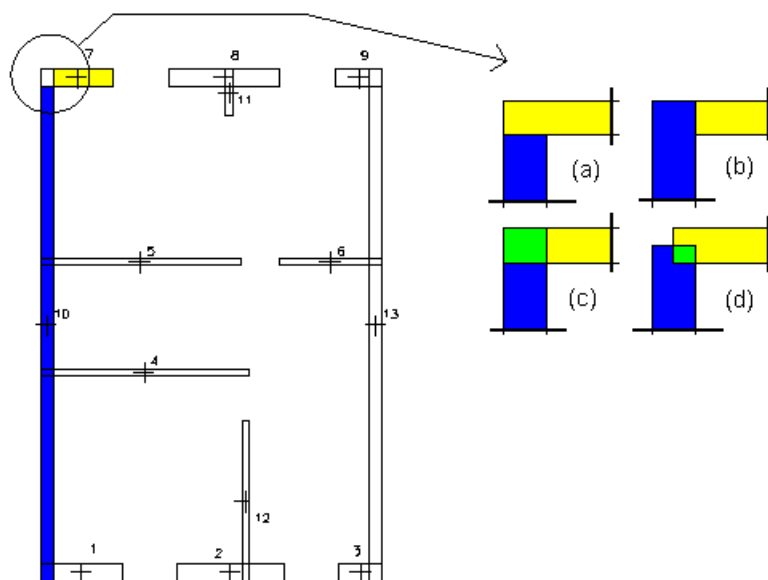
Pianta delle strutture tratta dalla pianta architettonica di Fig. 27.
